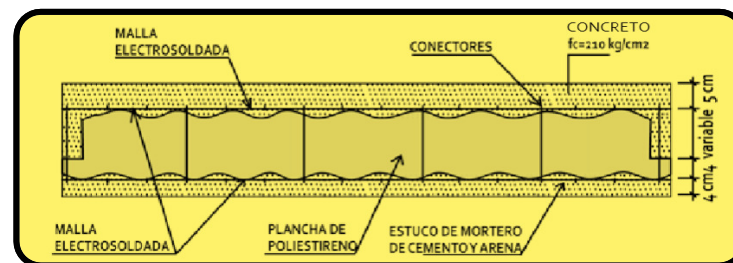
Panel losa con tres nervaduras para armado de viga (PL3).
